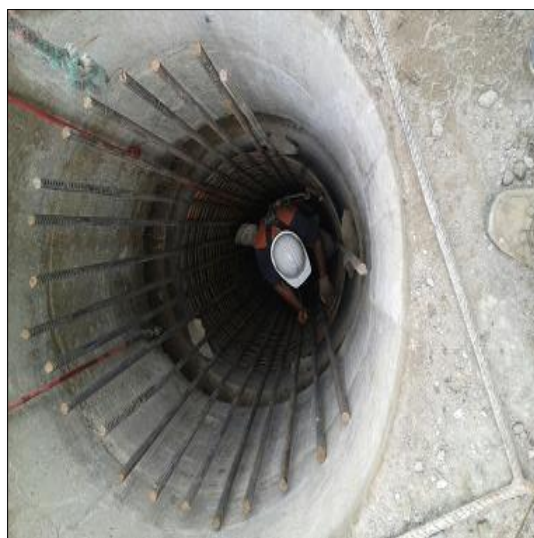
EXCAVACIÓN Y FUNDIDA DE NUCLEOS DE CAISSONS, FOTO 2: AMARRE ACERO DE REFUERZO
